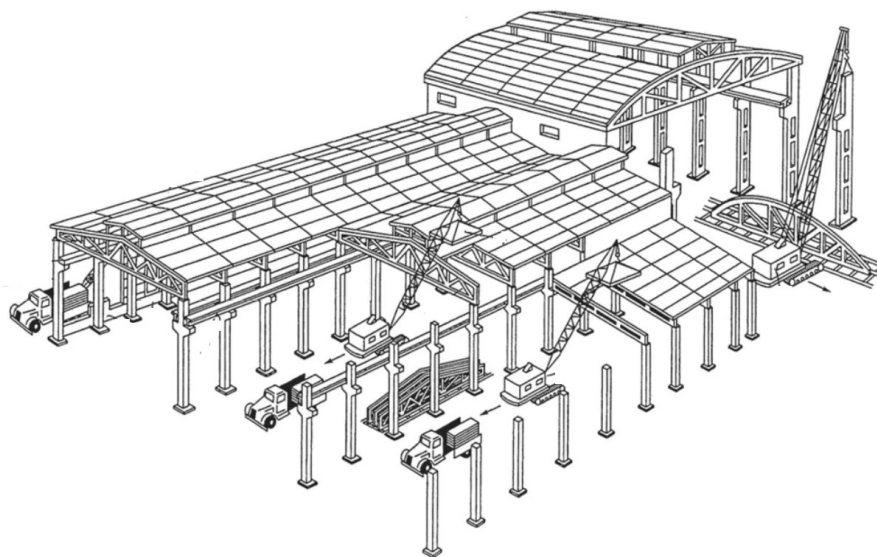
Схема расположения кранов при монтаже конструкций
